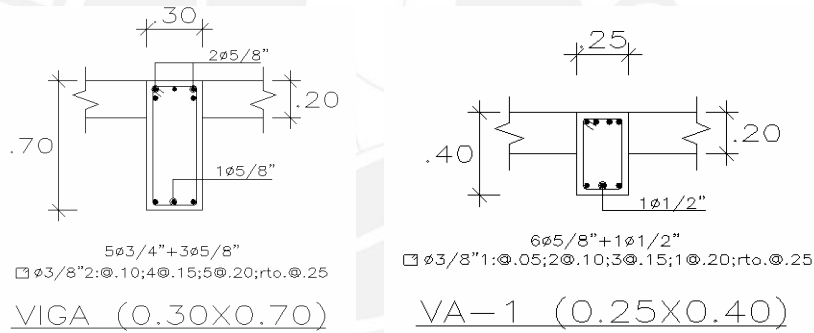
Detalle de vigas de concreto armado (Edificio 780 pre NDSR-1997)
